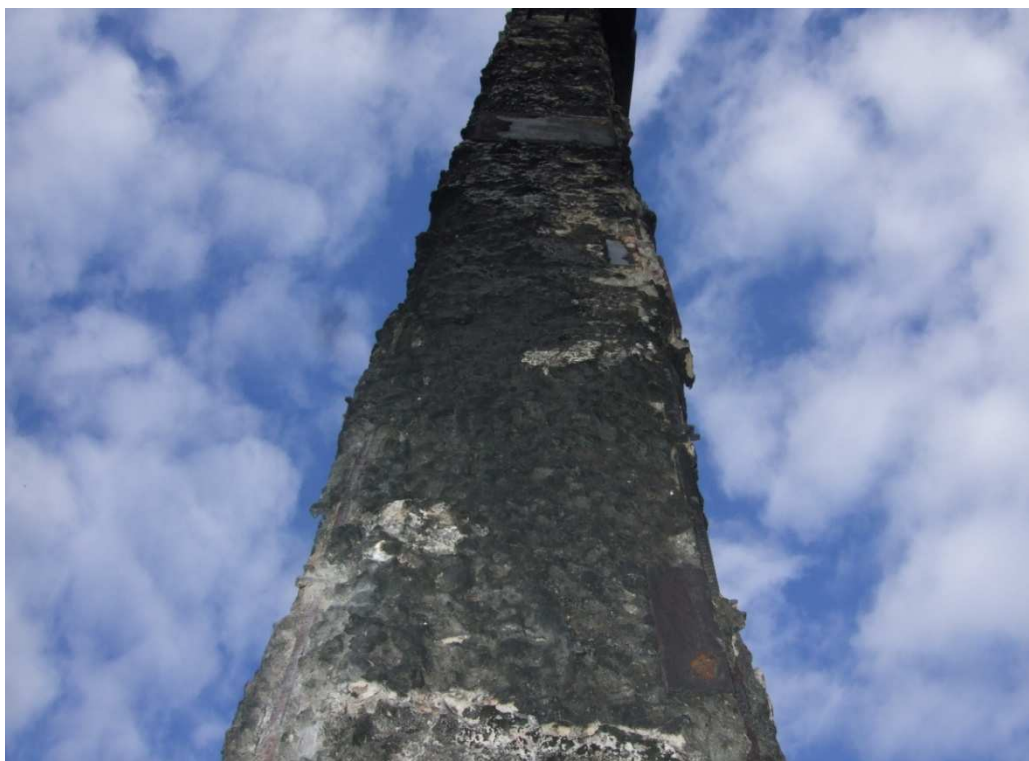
Збірна залізобетонна колона, що втратила до 30% бетонного поперечного перерізу в результаті обгорання
